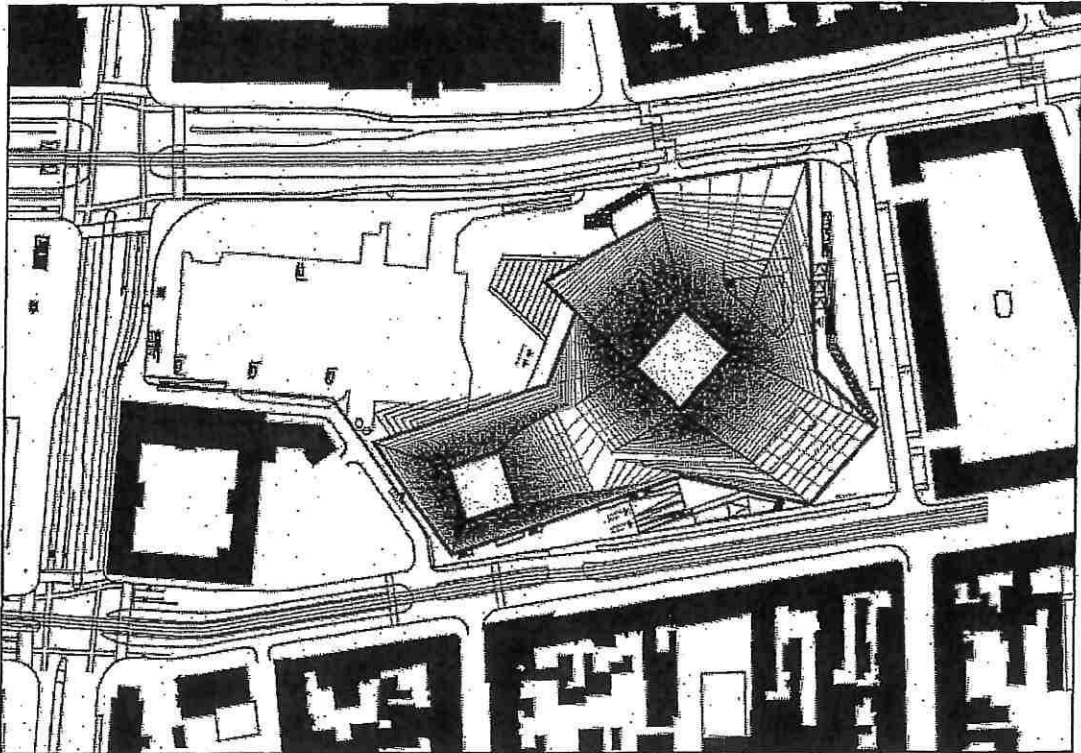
Lageplan Badisches Staatstheater nach der Modernisierung und Erweiterung
